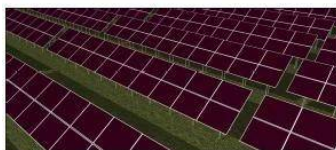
VEDUTA PROSPETTICA COMPLESSIVA
